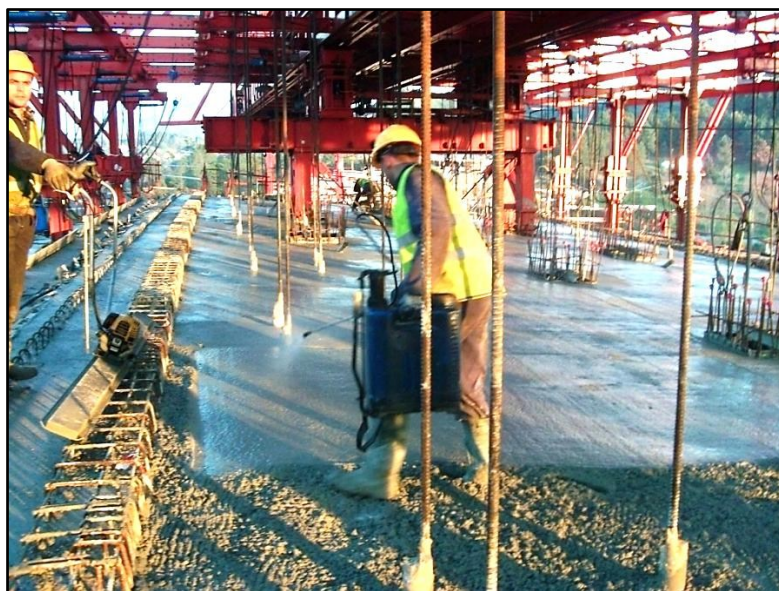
Fase de betonagem; uso de régua vibratória para sarrafar o betão; aplicação de membrana protectora do betão
